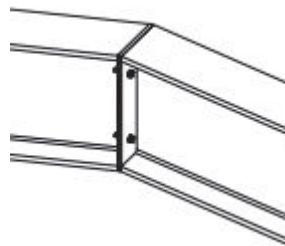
Ligação viga - pilar e viga -viga – Regiões de soldagem
